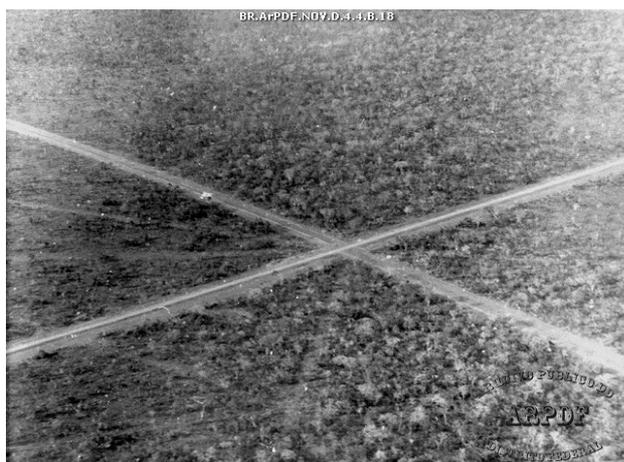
Projeto do Plano Piloto de Brasília, 1957.
